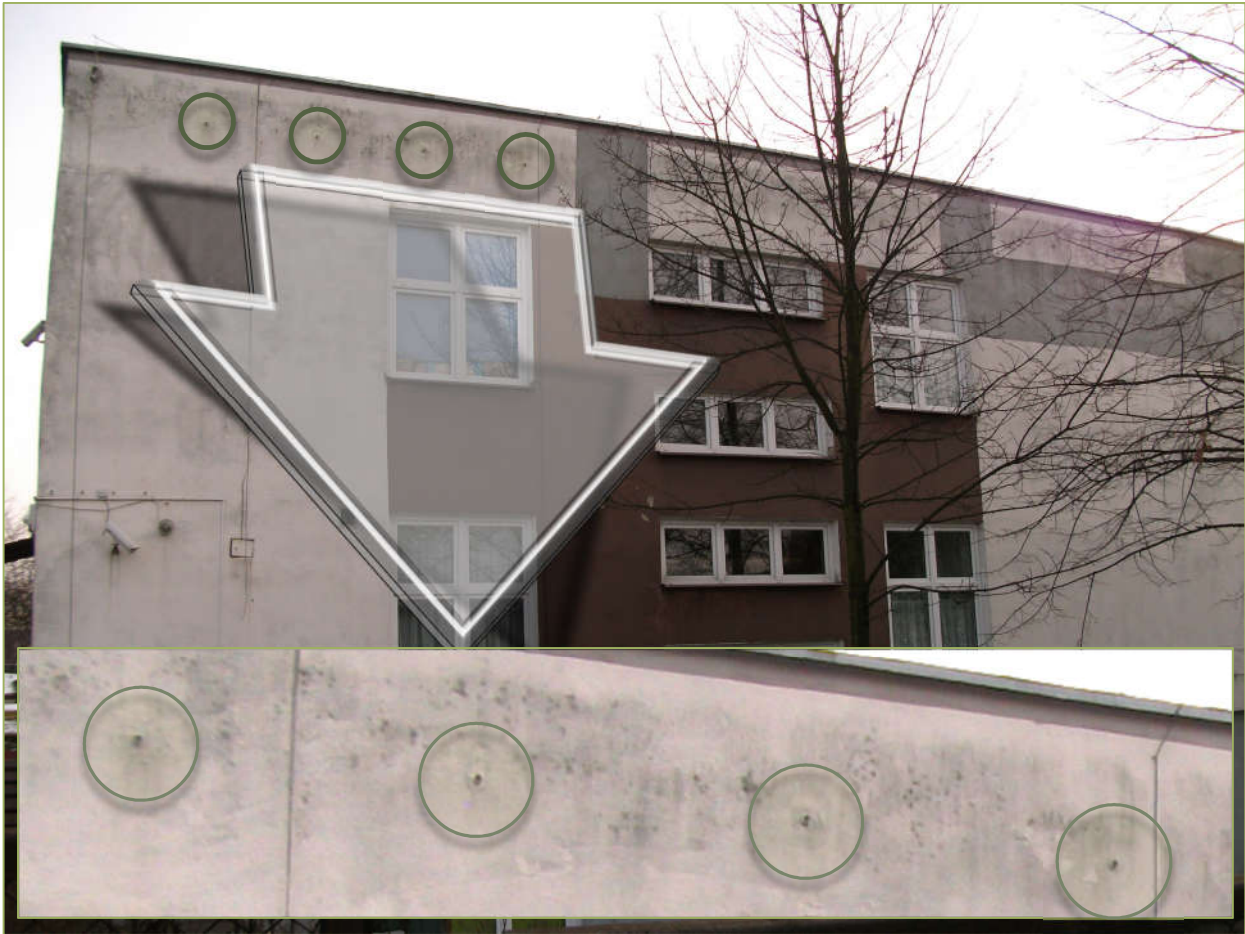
Elewacja południowa – tu również liczne otwory zajęte przez ptaki.
